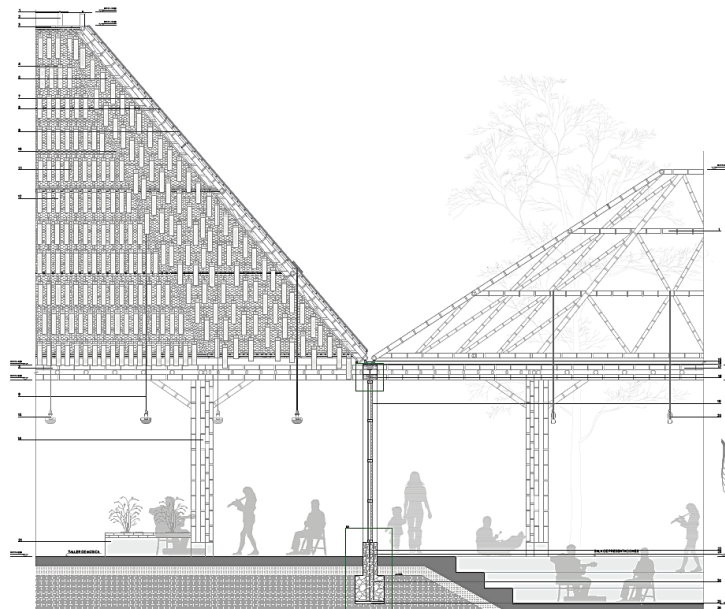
Estructura interna de bambú acústico de cubierta. Fuente: Elaboración propia.
